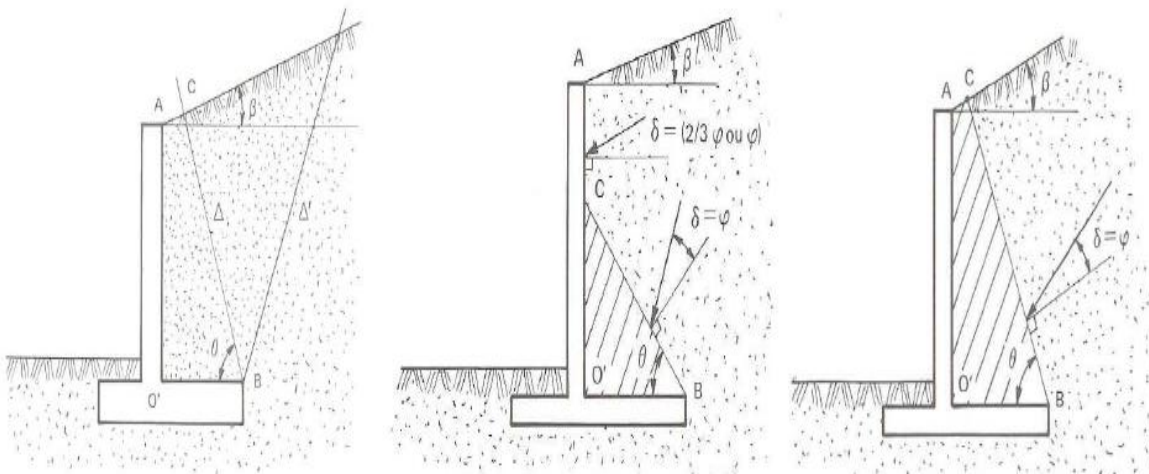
Principe de fonctionnement d'un mur Cantilever
